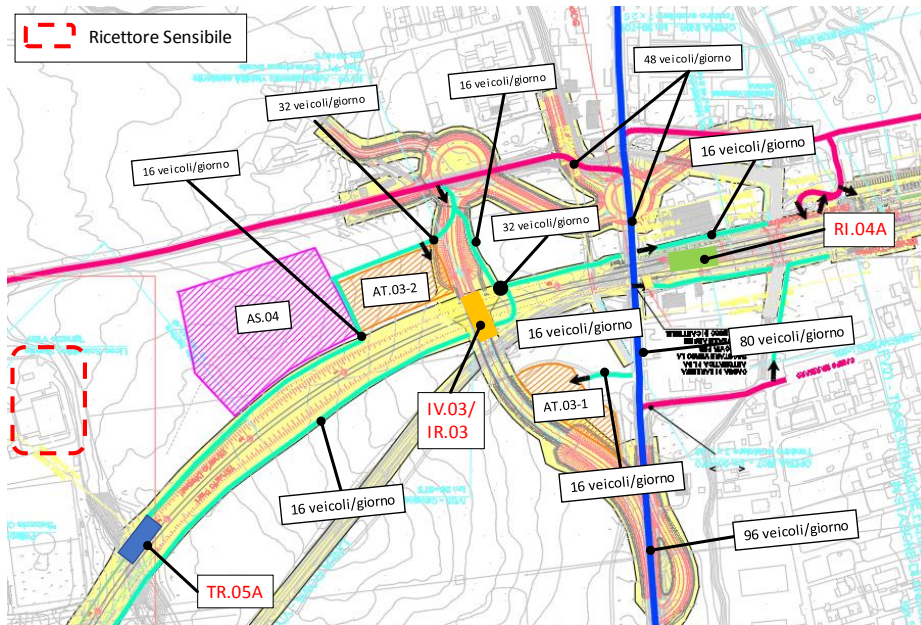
Distribuzione dei traffici di cantiere in planimetria
